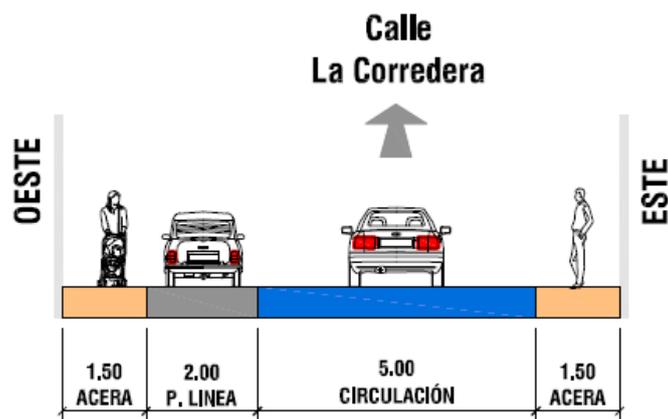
Sección de la calle Puerta de Aguilar. Fuente: DOYMO
